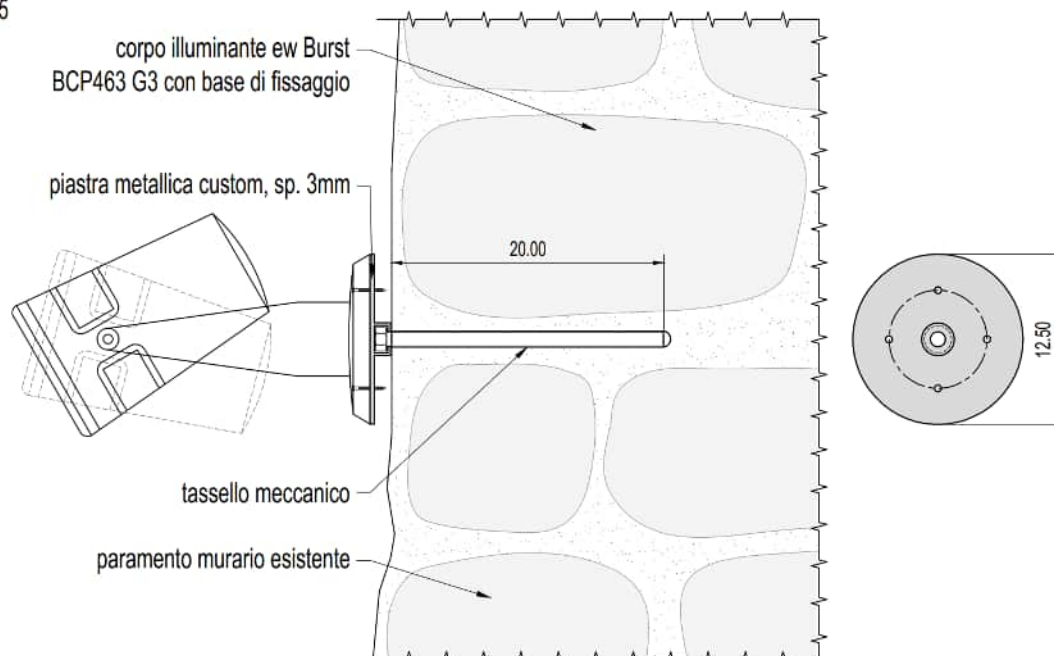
Progetto – Dettaglio ancoraggio corpi illuminanti su paramento verticale
